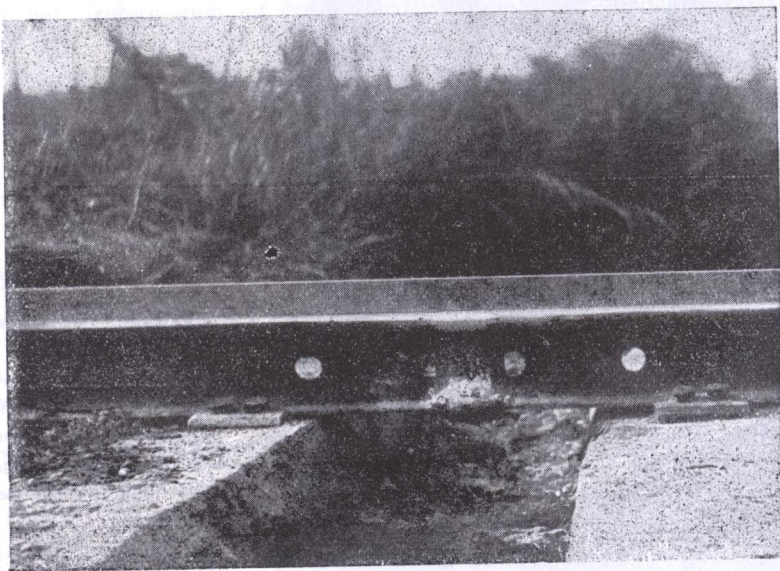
Der gleiche Schienenstoß mit Schweißmasse „Thermit“ geschweißt
